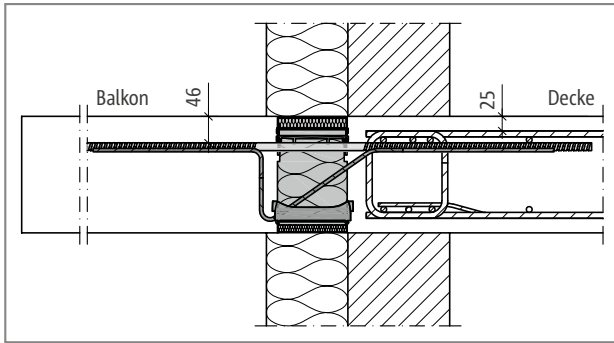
Schöck Isokorb® CXT Typ K-CV46: Anschluss bei deckengleichem Unterzug
